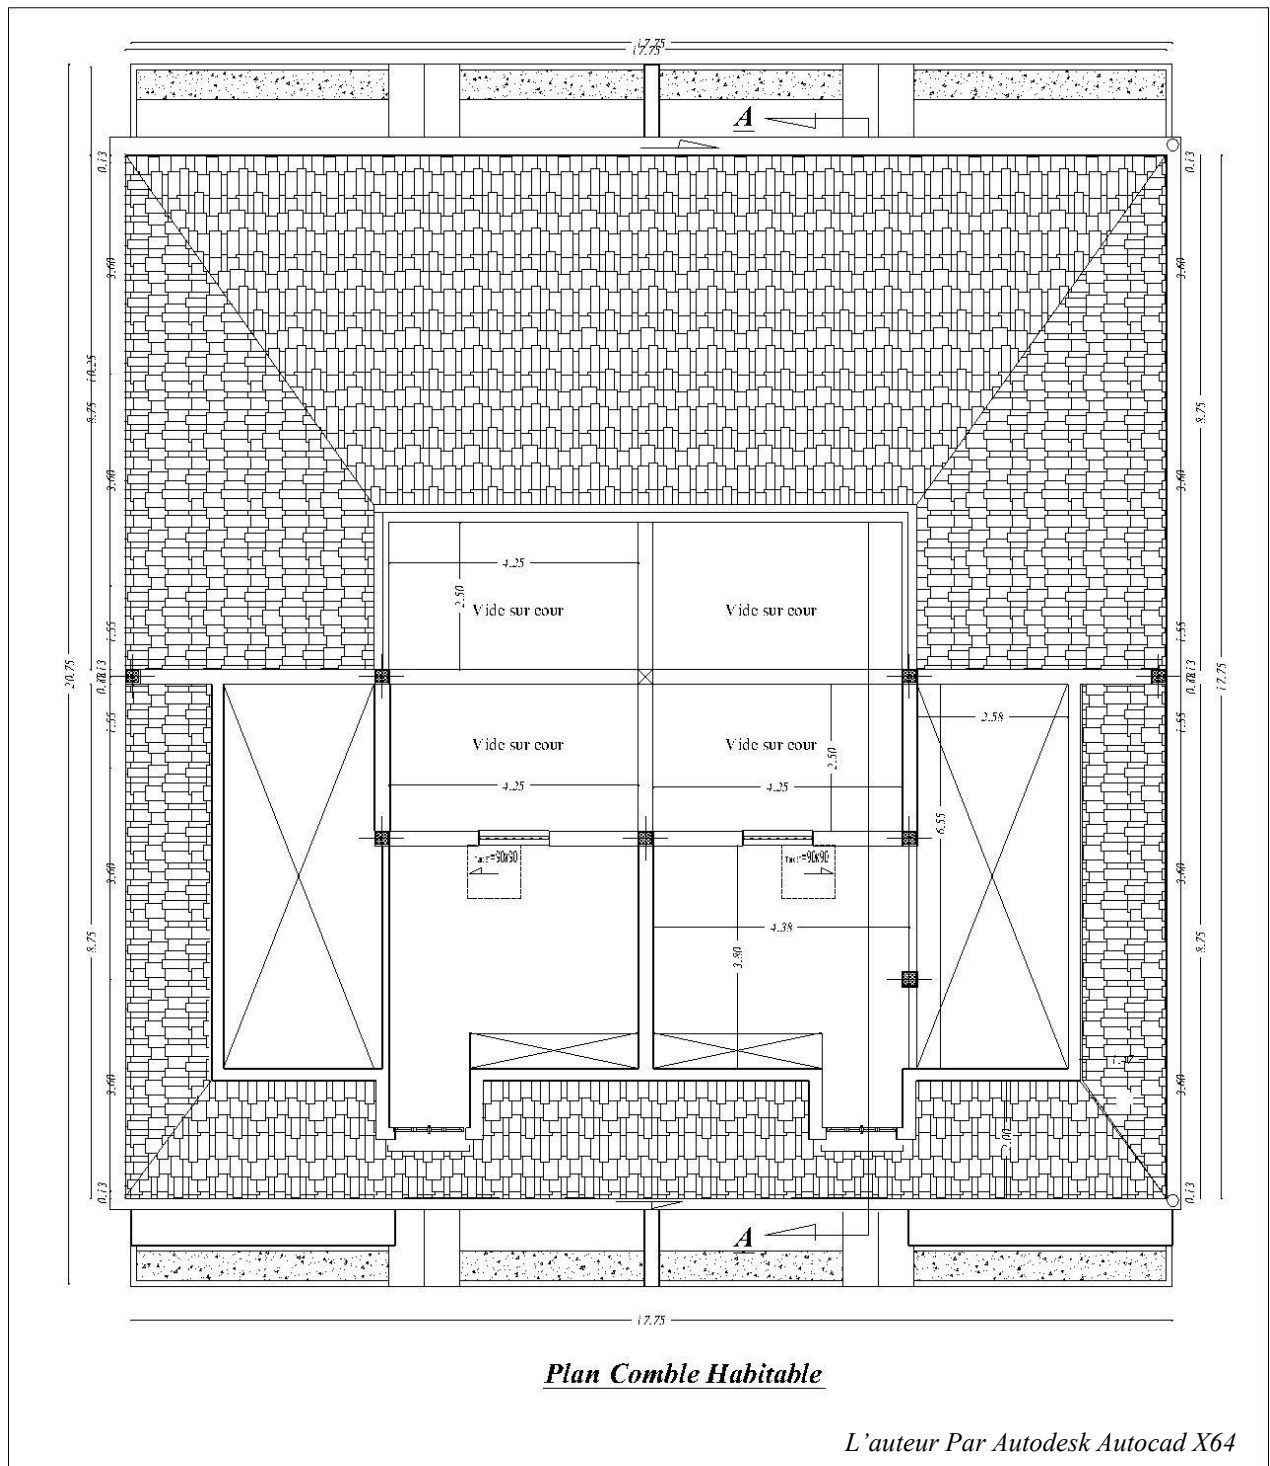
Plan d'ensemble toiture « etat aménagé »
